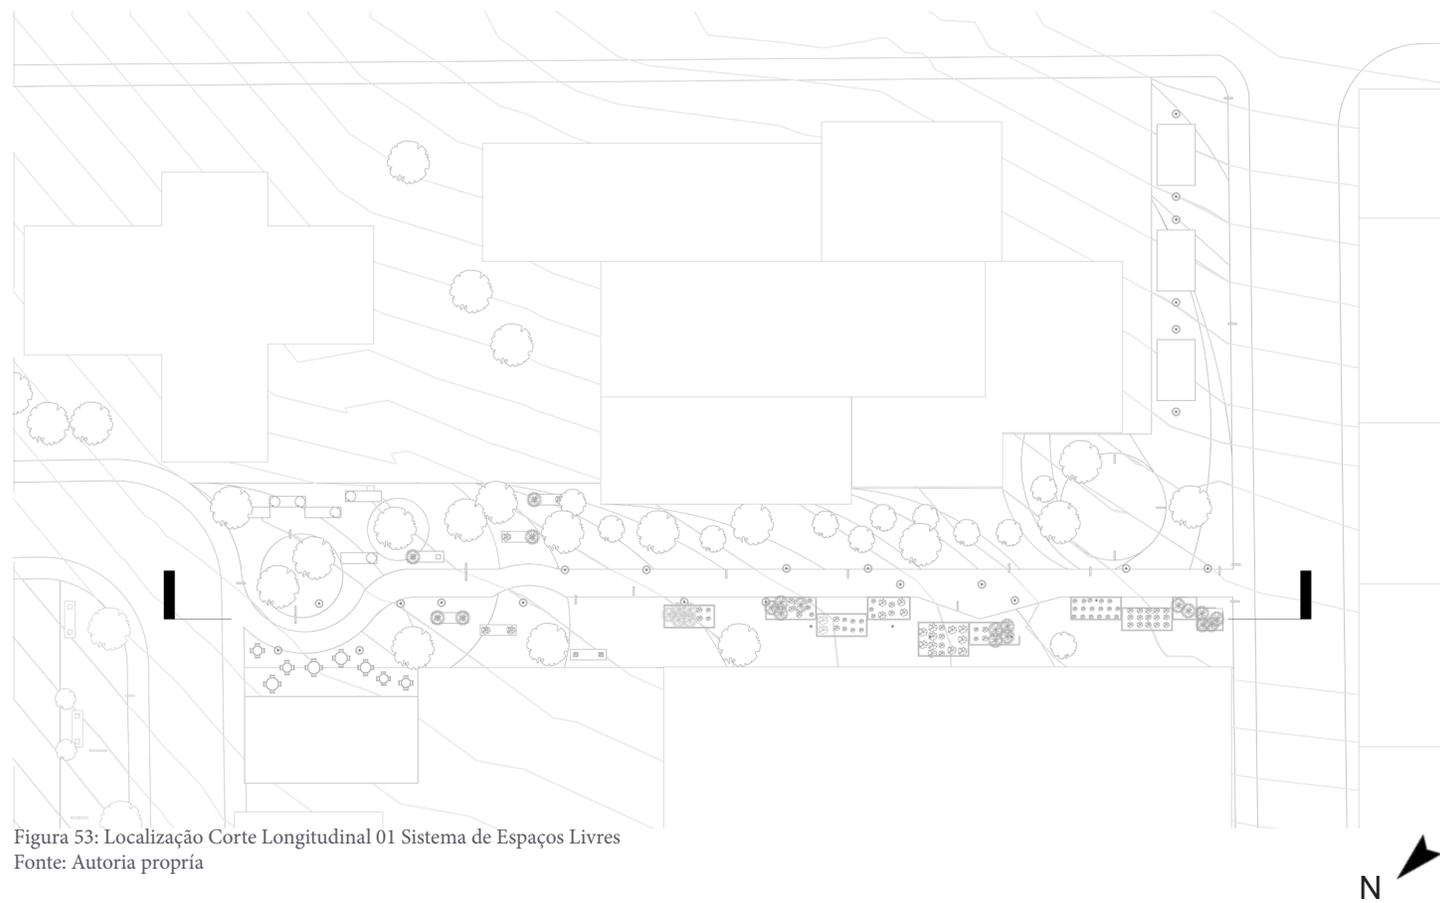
Localização Corte Longitudinal 01 Sistema de Espaços Livres
